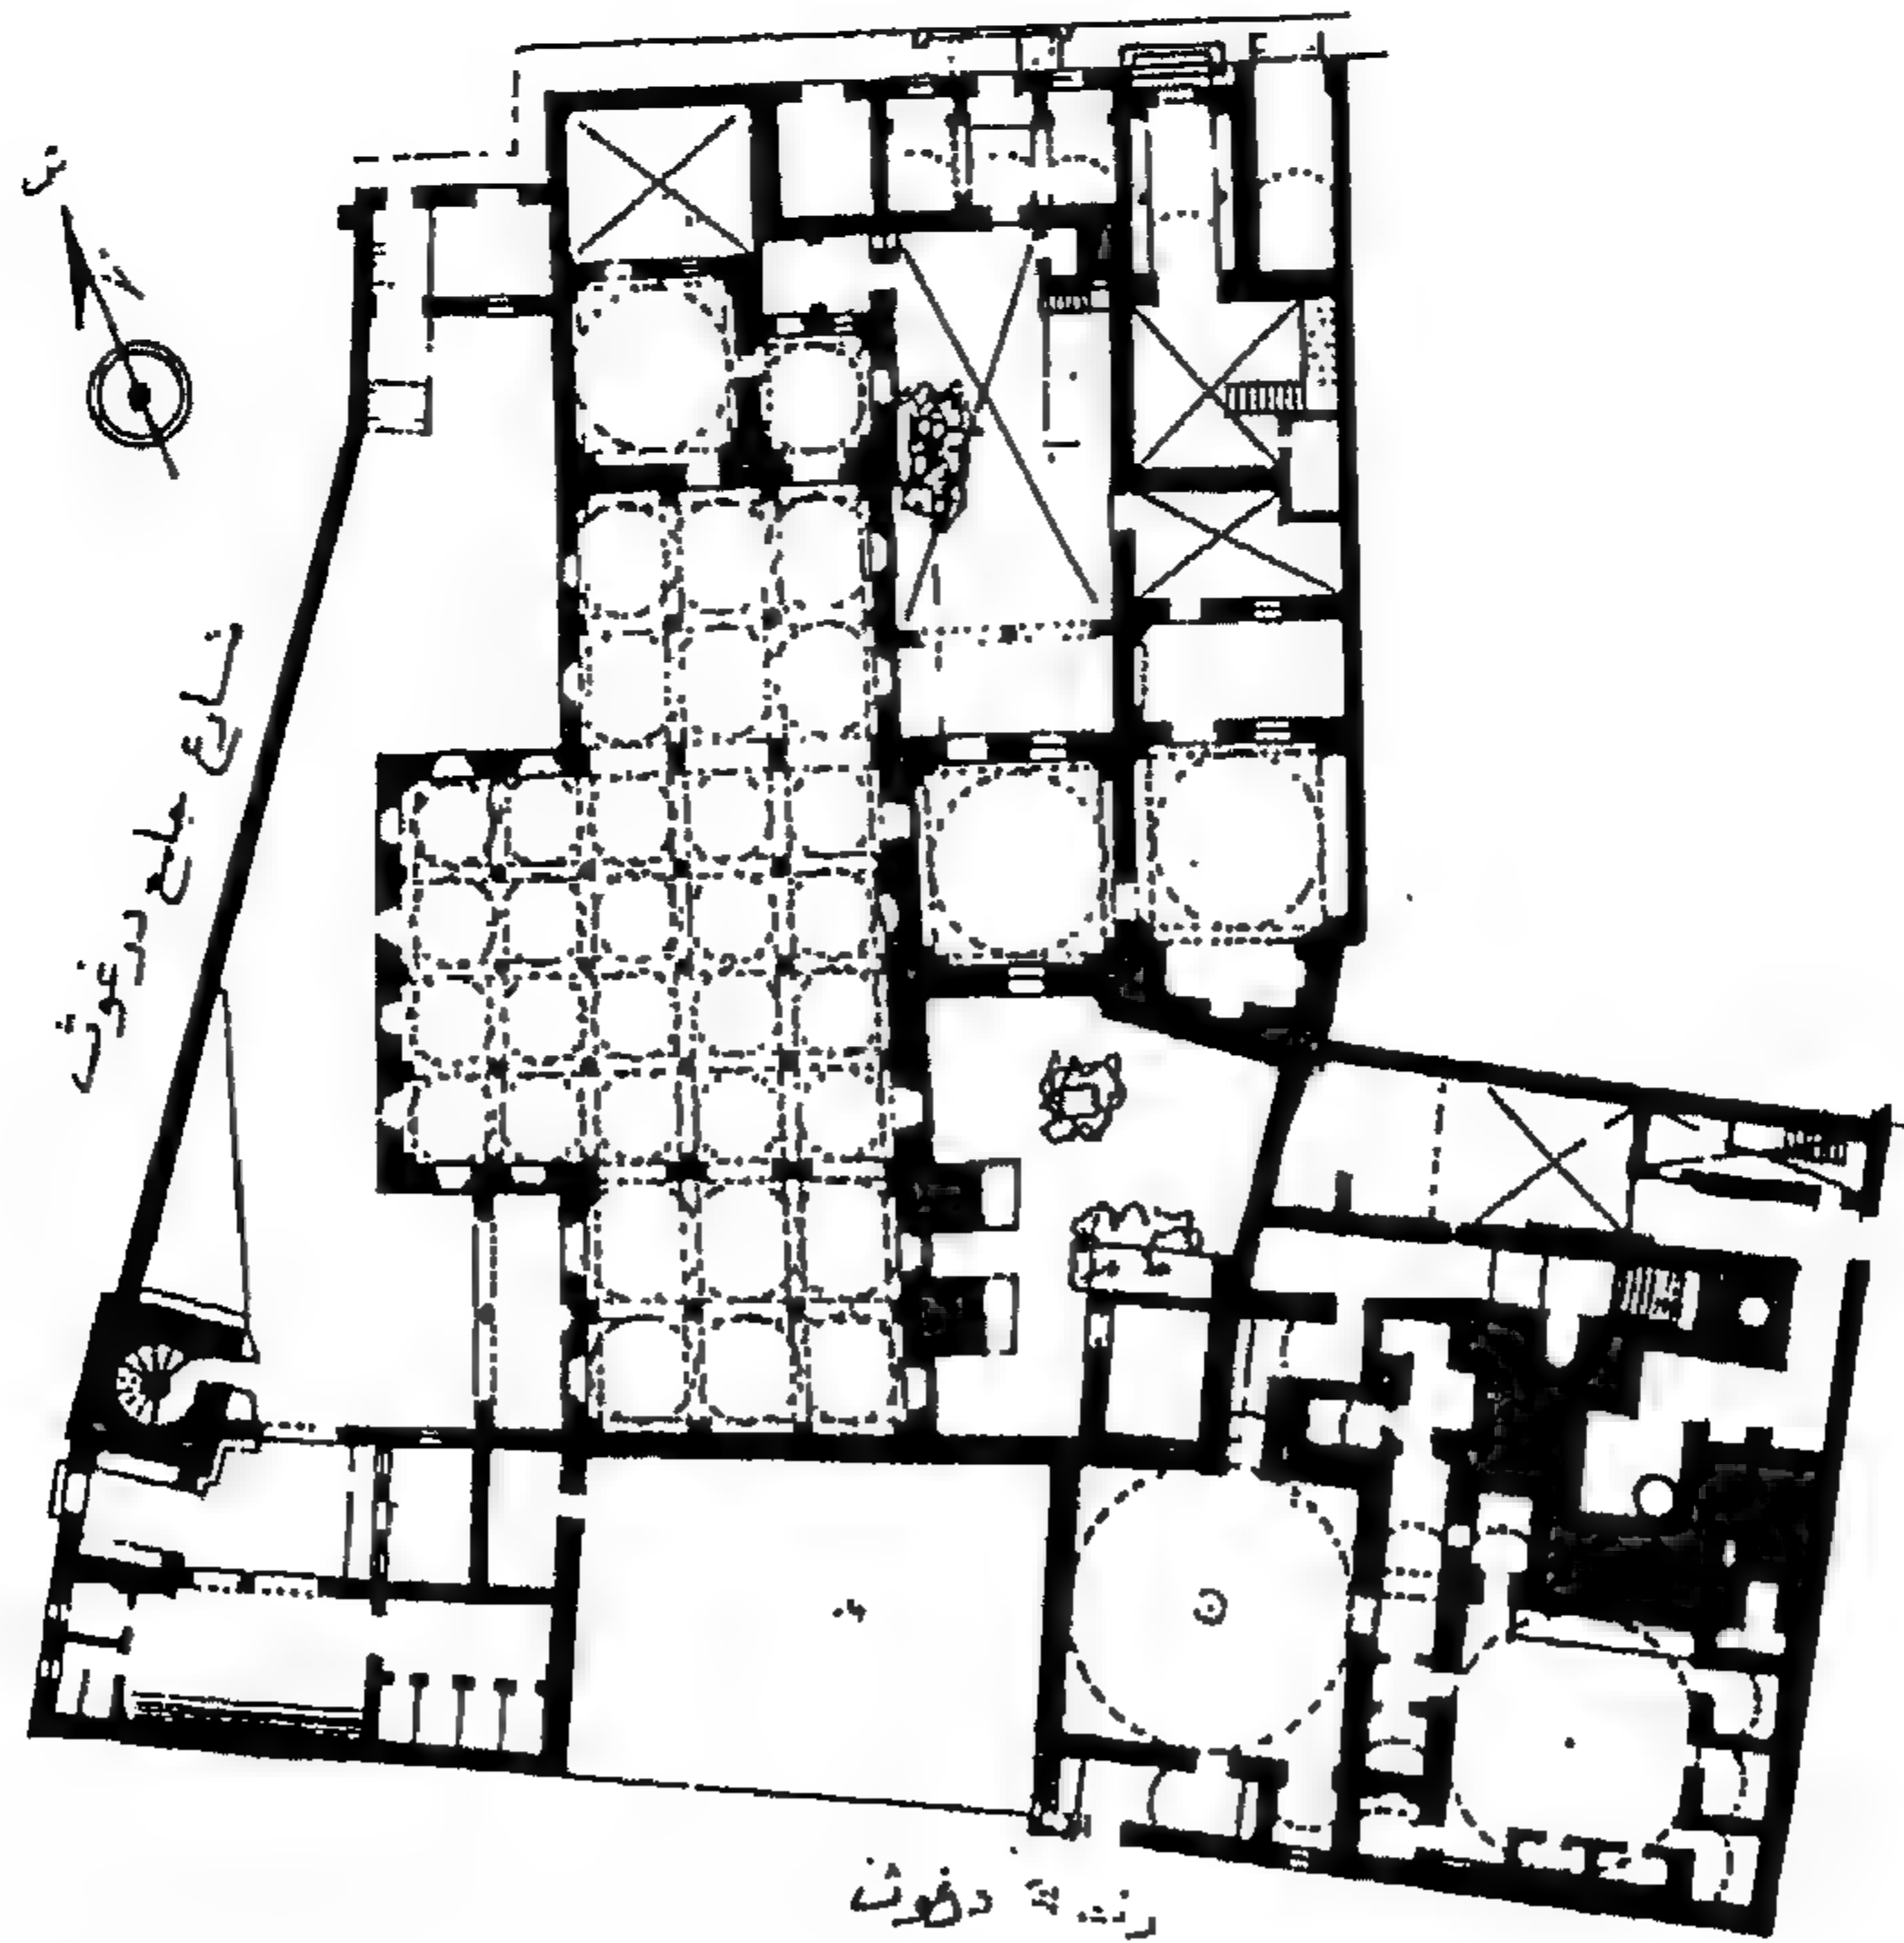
مسقط أفقي لجامع الخروبة بطرابلس الغرب في ليبيا.
